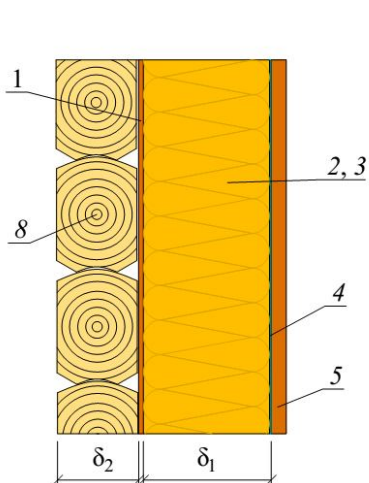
Конструкция бревенчатой стены с внутренней и наружной тепловой изоляцией: 1 – обшивка; 2 – рейка с шагом 0,6 м; 3 – тепловая изоляция; 4 – пароизоляция; 5 – обшивка; 6 – 20 мм вентилируемого слоя; 7 – наружная облицовка; 8 – бревенчатая стена
